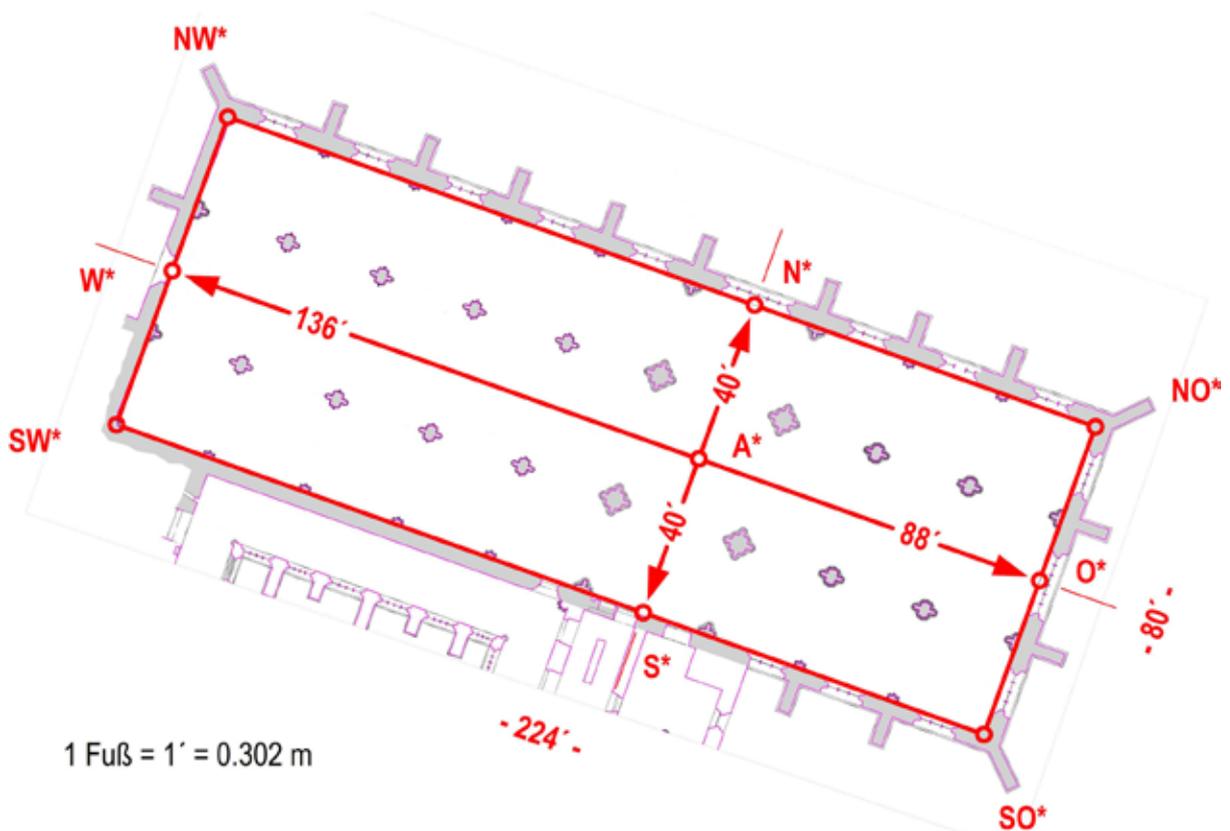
Münster Neuberg, Abweichungen zwischen Planung und Ausführung in stark übertriebener Darstellung (Abweichungen gegenüber Maßstab Grundriss 30-fach vergrößert).
